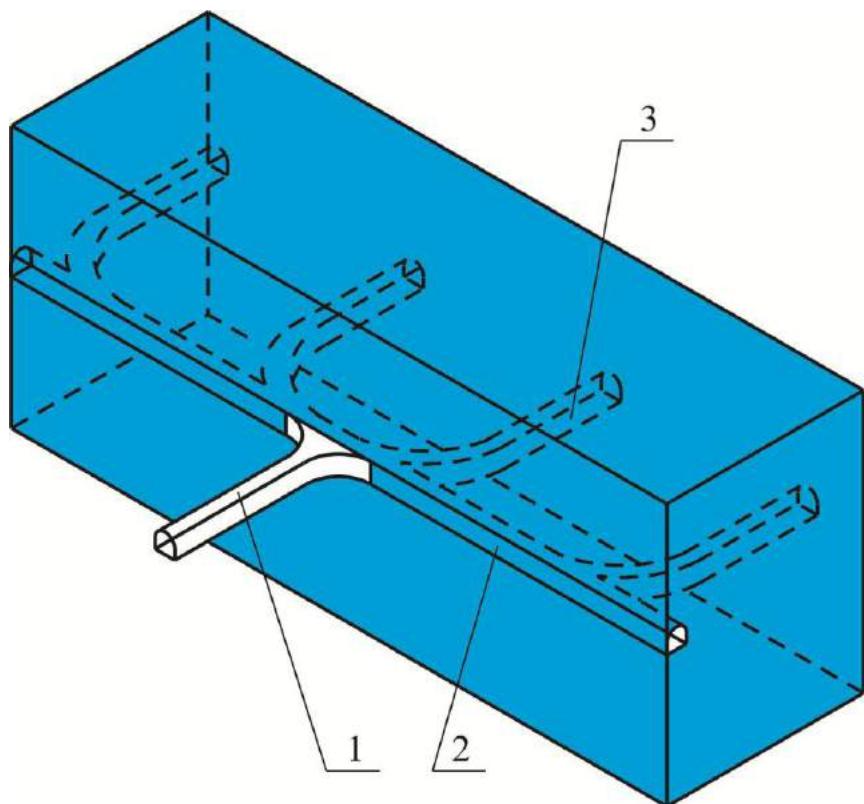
Схема подготовки рудным штреком и тупиковыми ортами: 1 – квершлаг; 2 – рудный штрек; 3 – тупиковый орт
